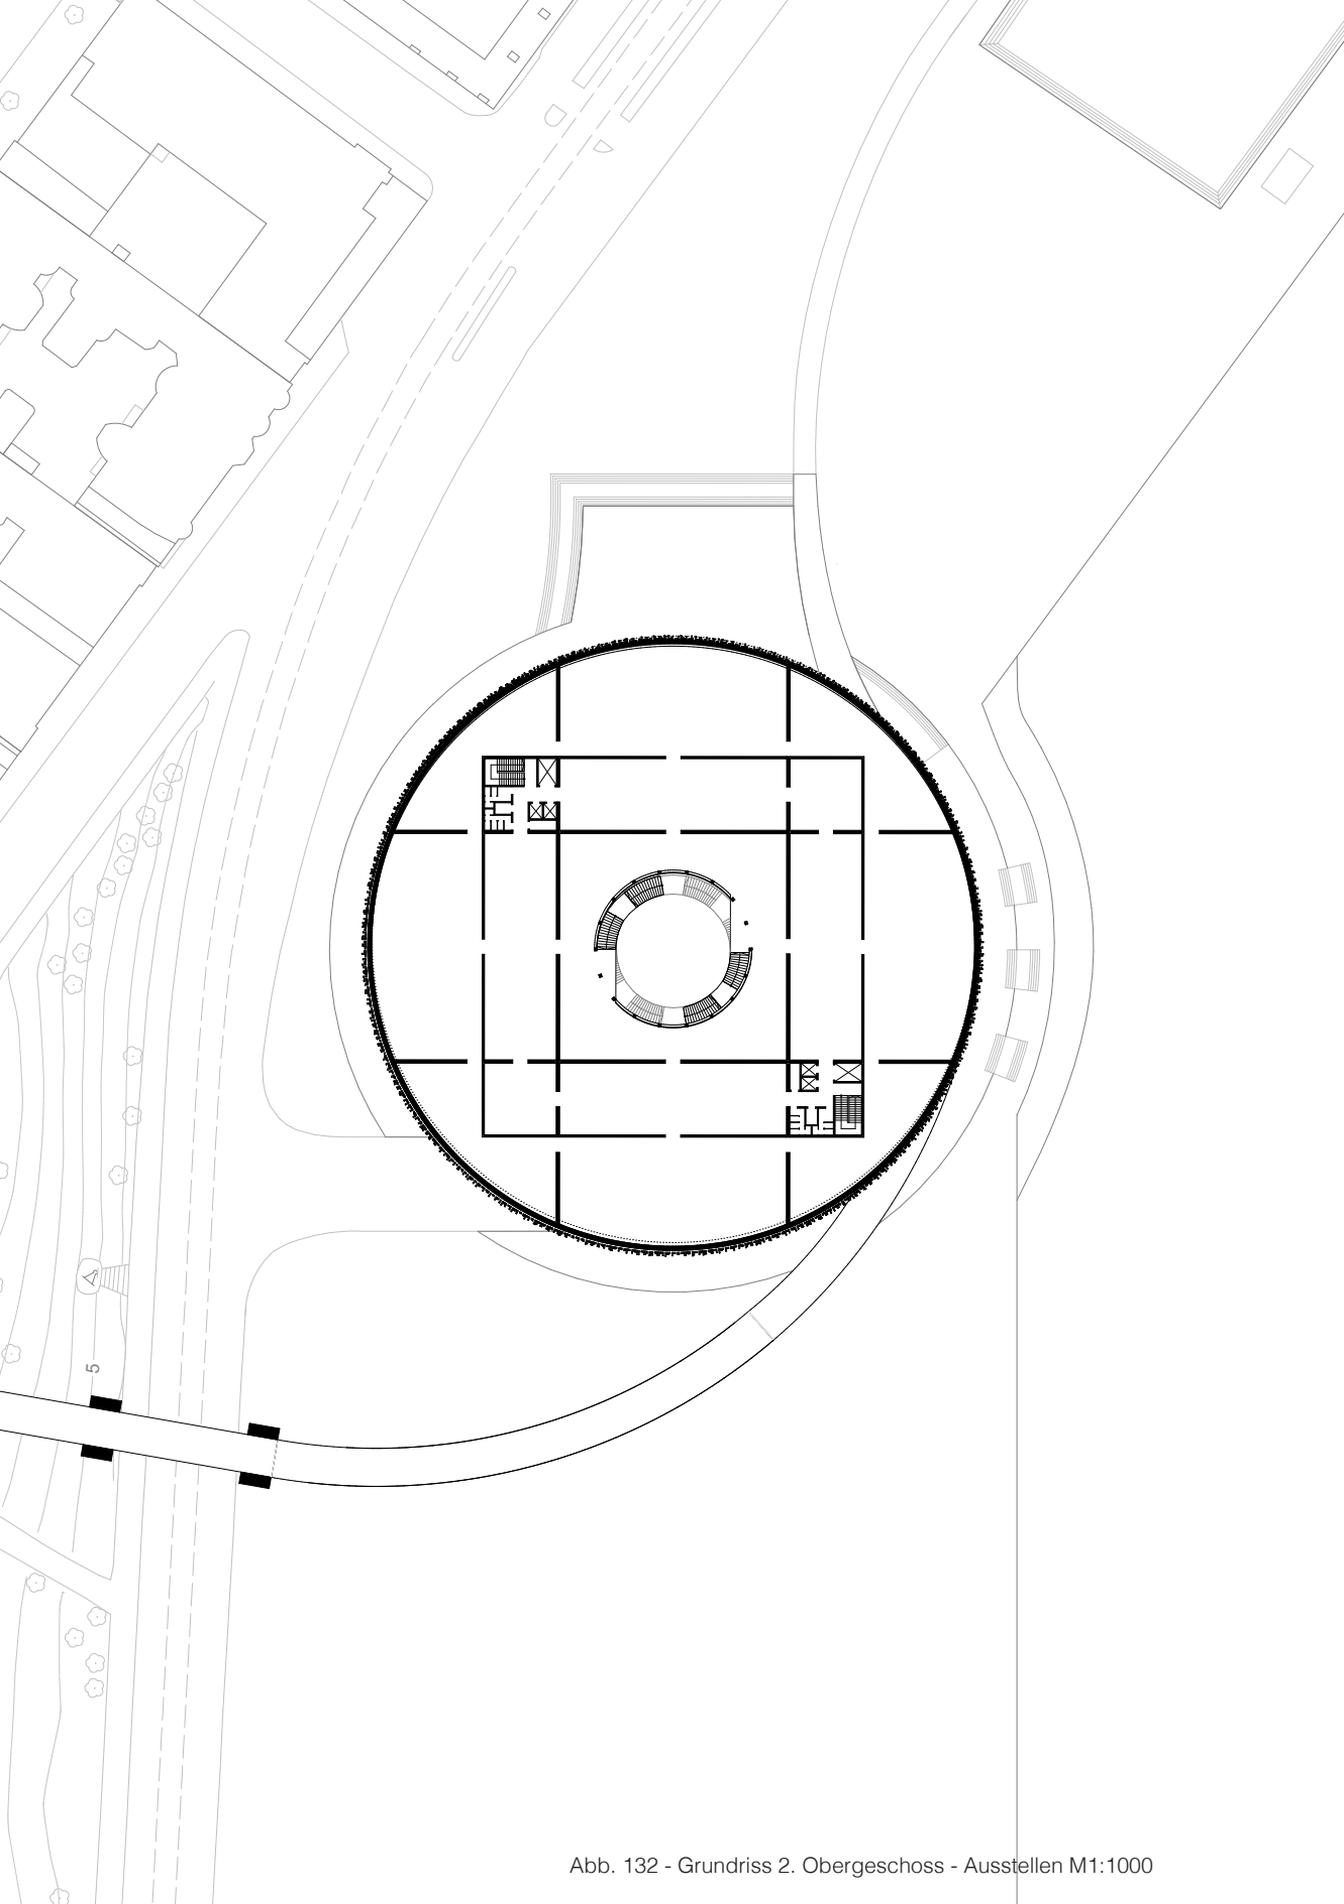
Grundriss 2. Obergeschoss - Ausstellen M1:1000
